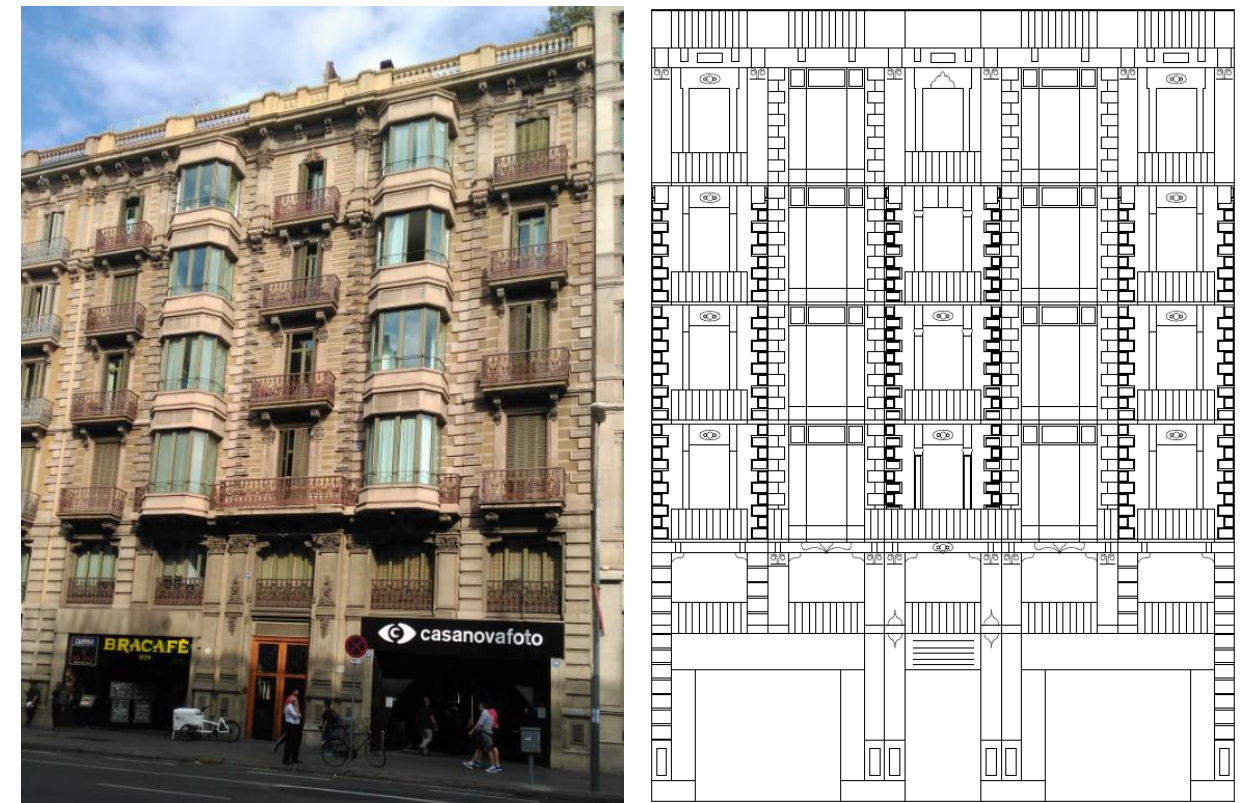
Fotografía y plano de fachada de c/ Ronda Universitat 35 de Barcelona
